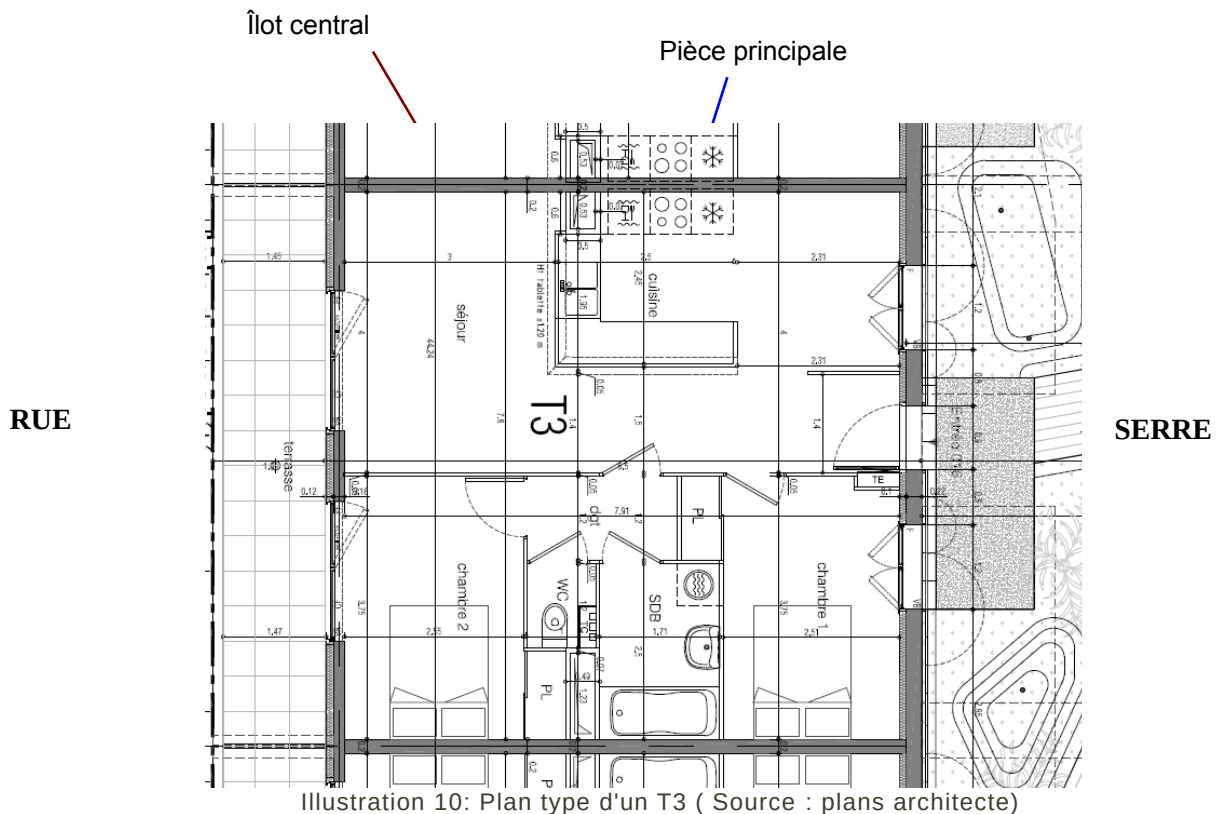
Plan type d'un T3 ( Source : plans architecte)
